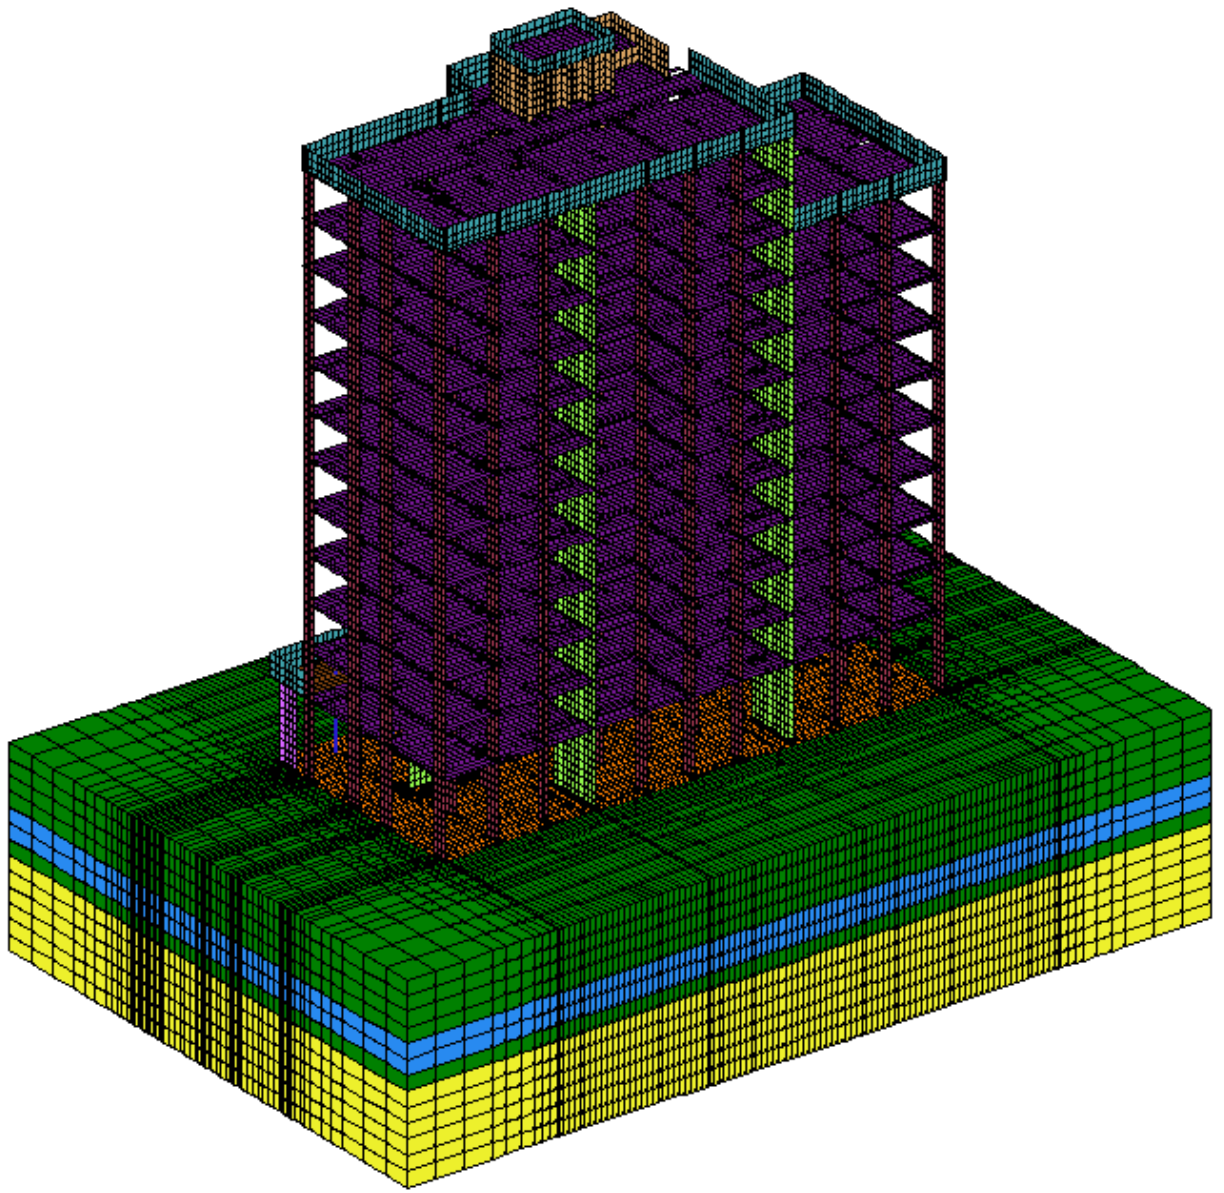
Схема будівлі на ґрунтовому масиві в ПК «ЛІРА» для фундаментів неглибокого закладання
